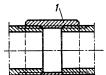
Резьбовое соединение: 1 — резьбо-вая муфта.
